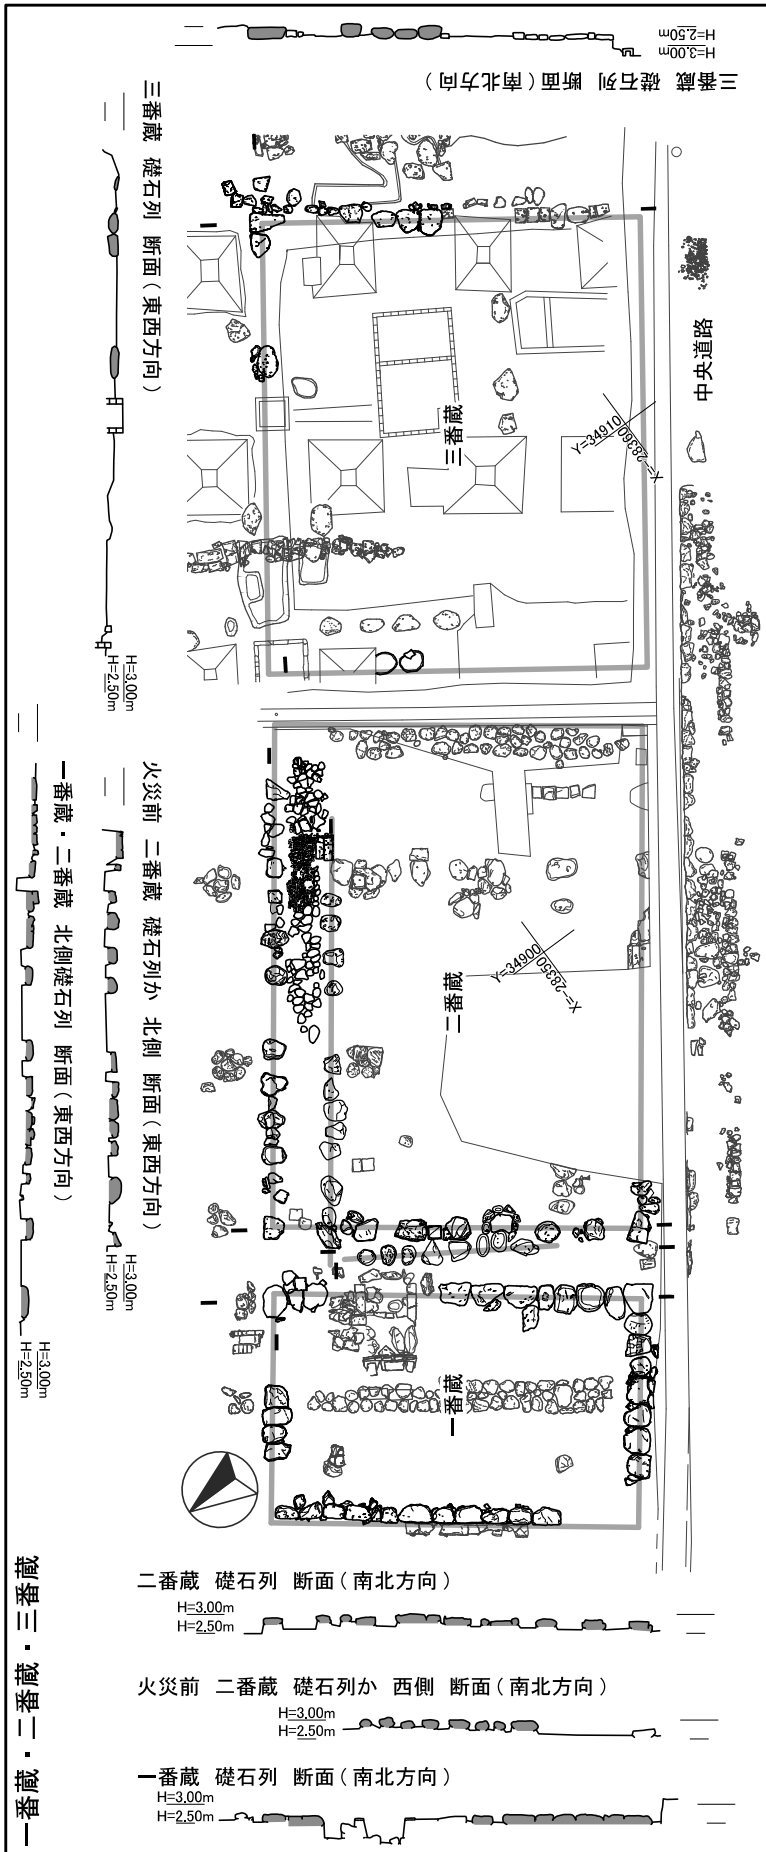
貿易品を納める蔵 平面図・断面図(S=1/200)
